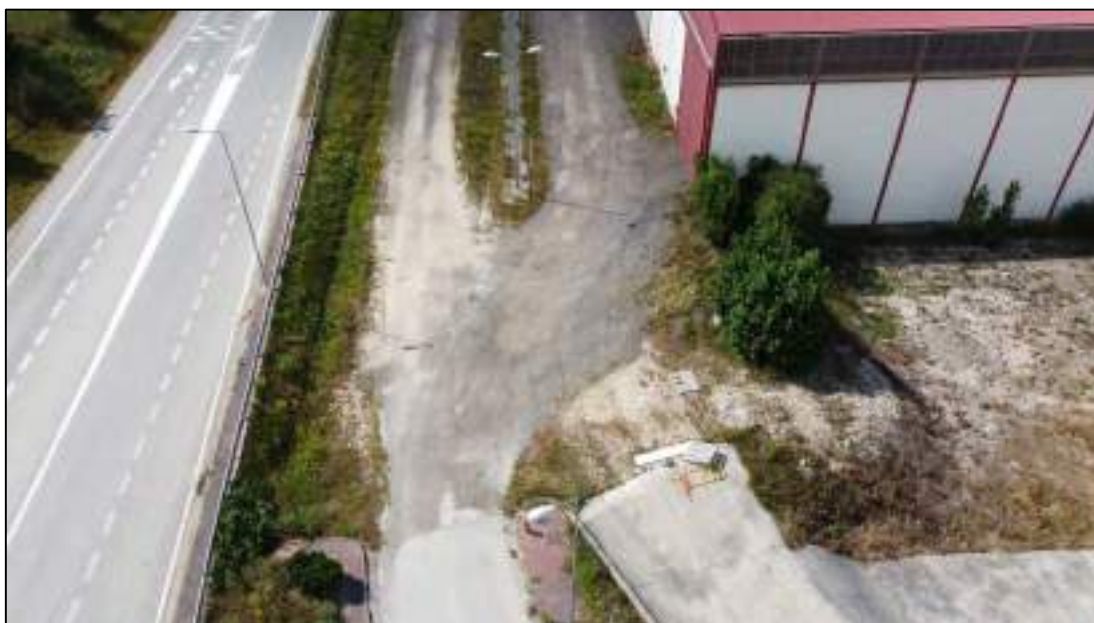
Detalle del encuentro con la parte pavimentada de la calle el Sapal.
